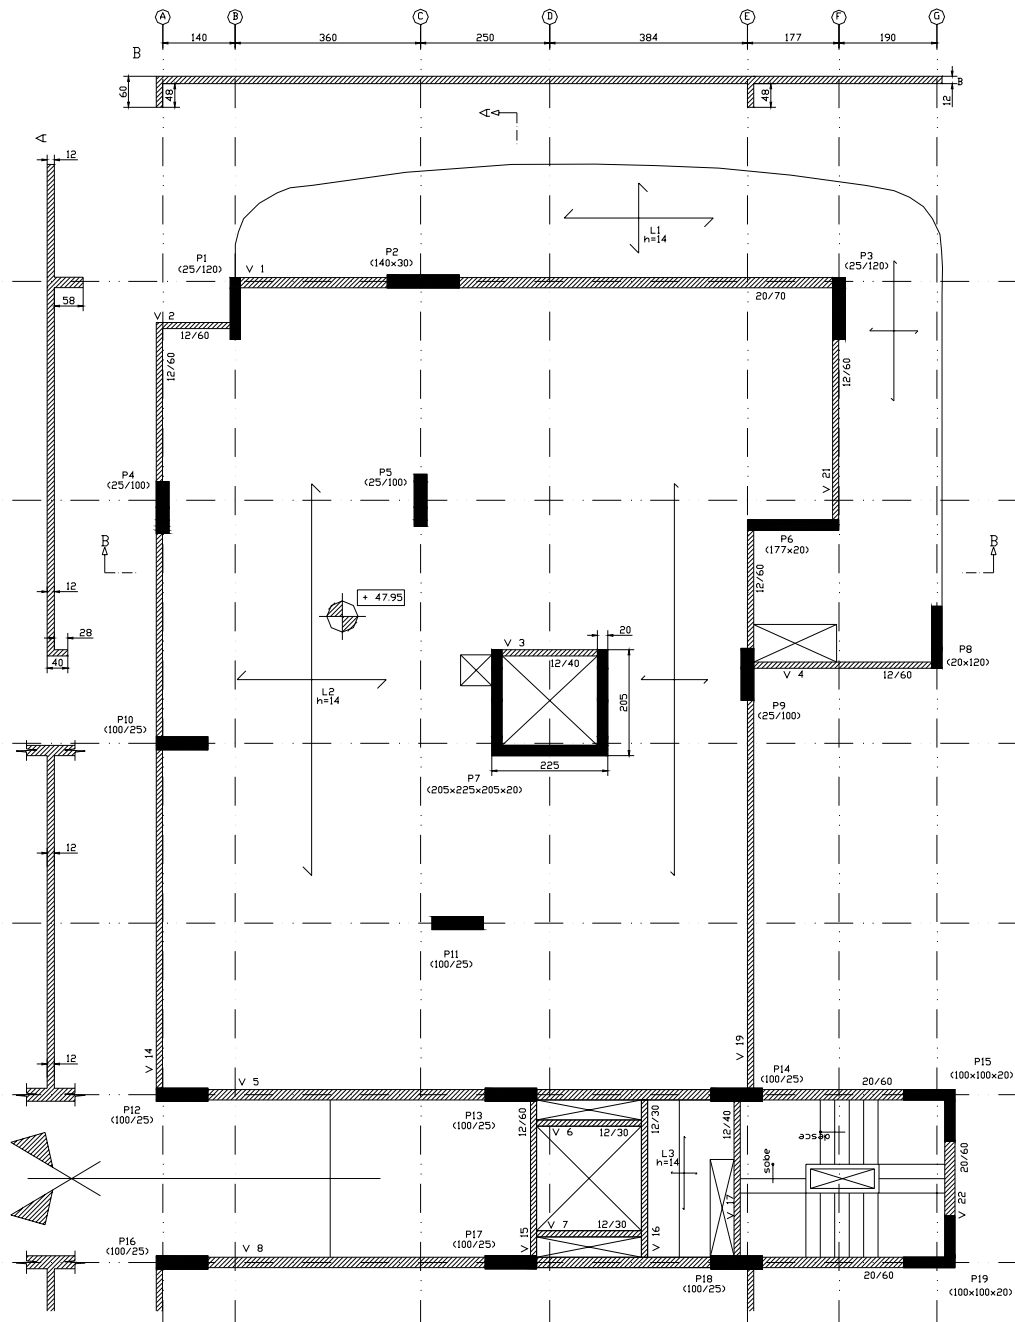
19 Planta de forma do projeto inicial (Pilares / Vigas / Lajes)
